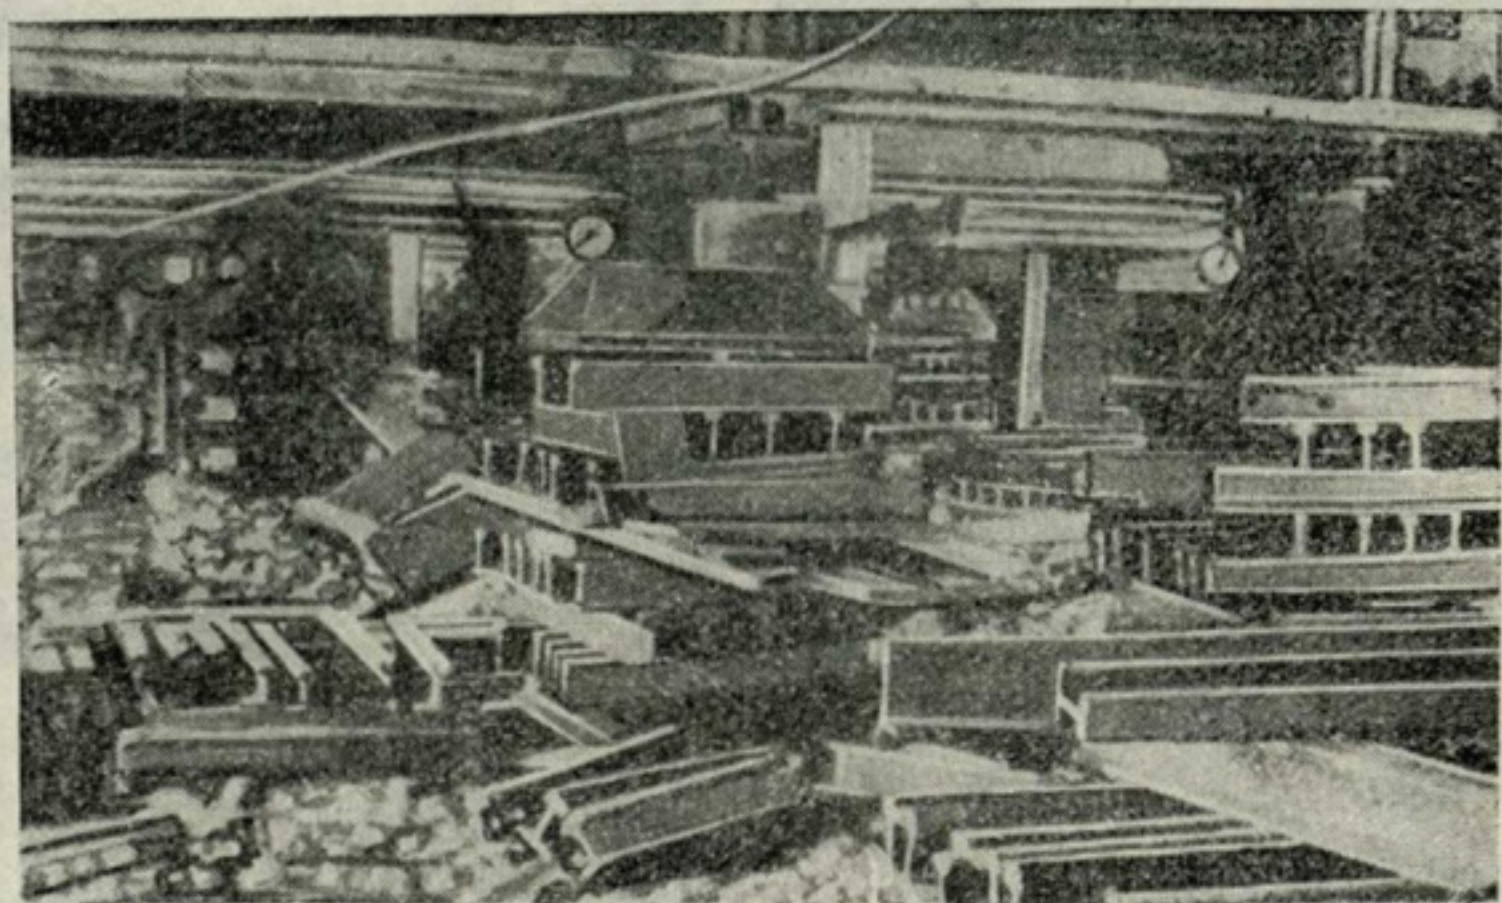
Передвижка дома № 5/16 по ул. Серафимовича. Впереди видны мощные гидравлические домкраты типа «Перпетуум». Над ними — рандбалки, заведенные в капитальные стены здания.
